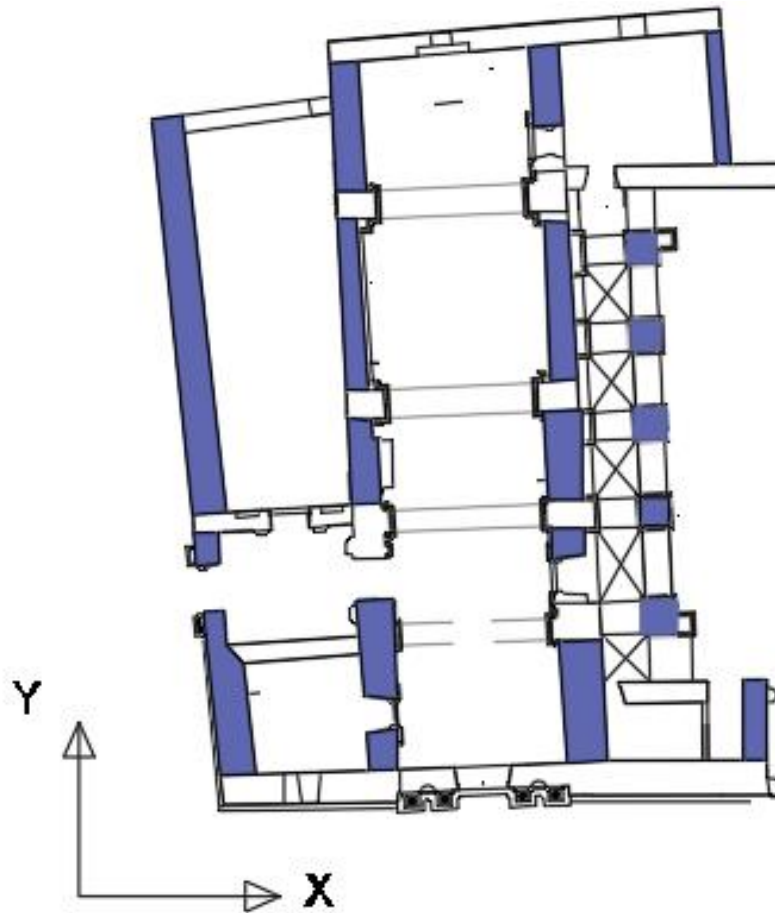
Área en planta de los muros resistentes en el eje Y.
